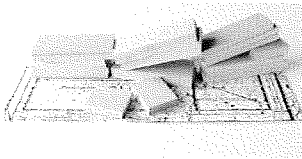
Die Form des Ensembles entstand im Modell.
